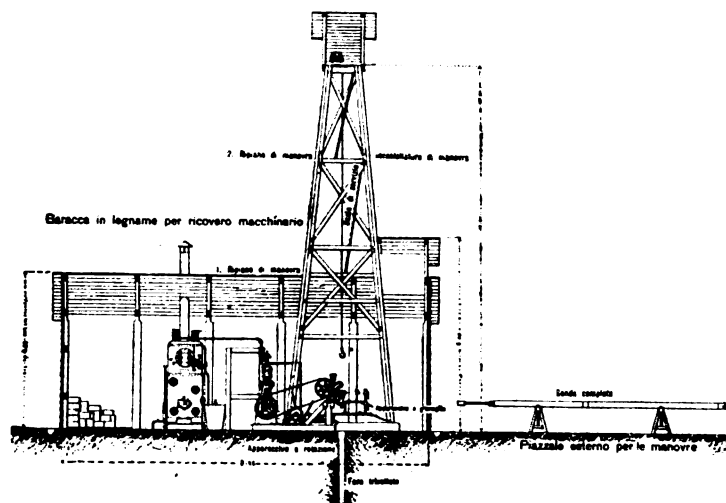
Disposizione generale per un impianto di trivellazione mediante sonda a rotazione Davis Calyx. Planimetria impianto di Baghede.
